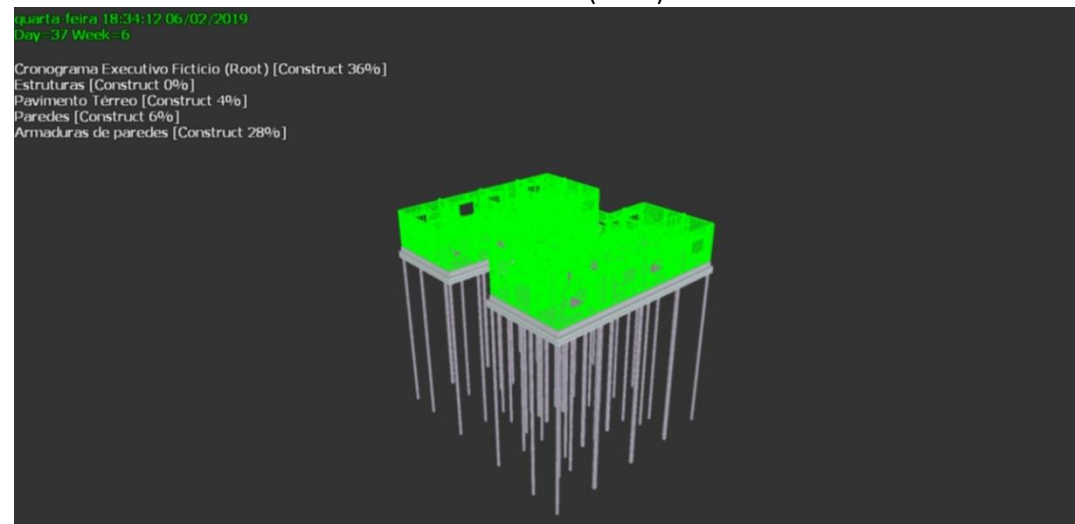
Telas de paredes do pavimento térreo sendo armadas (verde).
